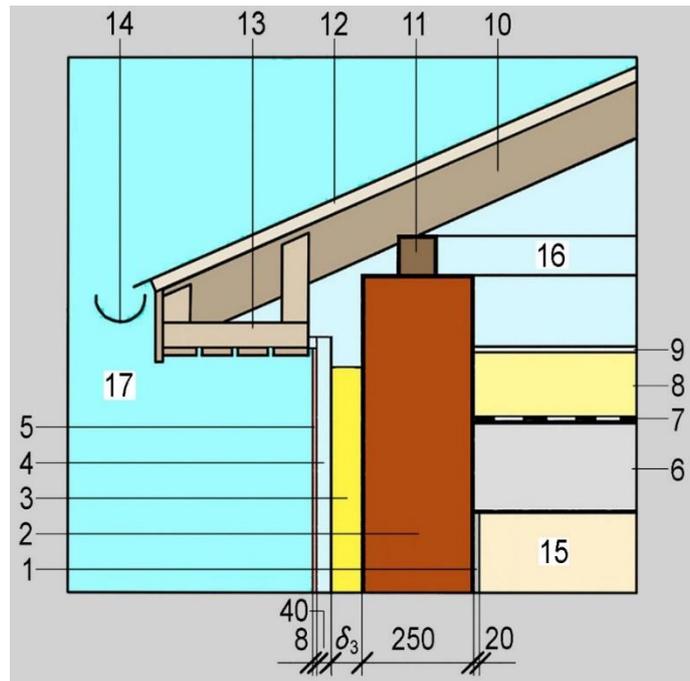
Фрагмент разреза здания (карнизный узел)
